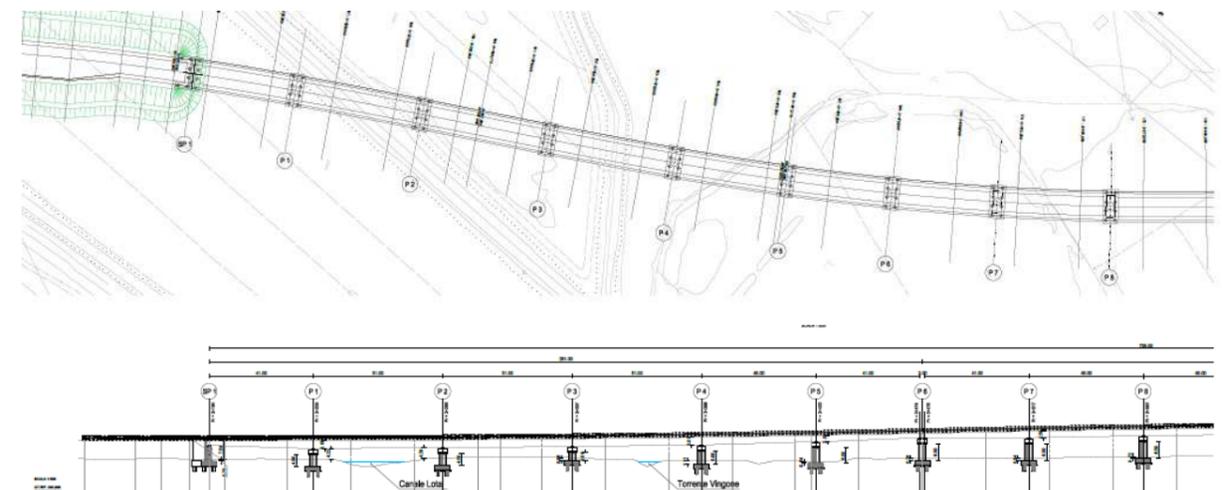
Pianta, profilo e sezione del Viadotto Canale Maestro della Chiana
